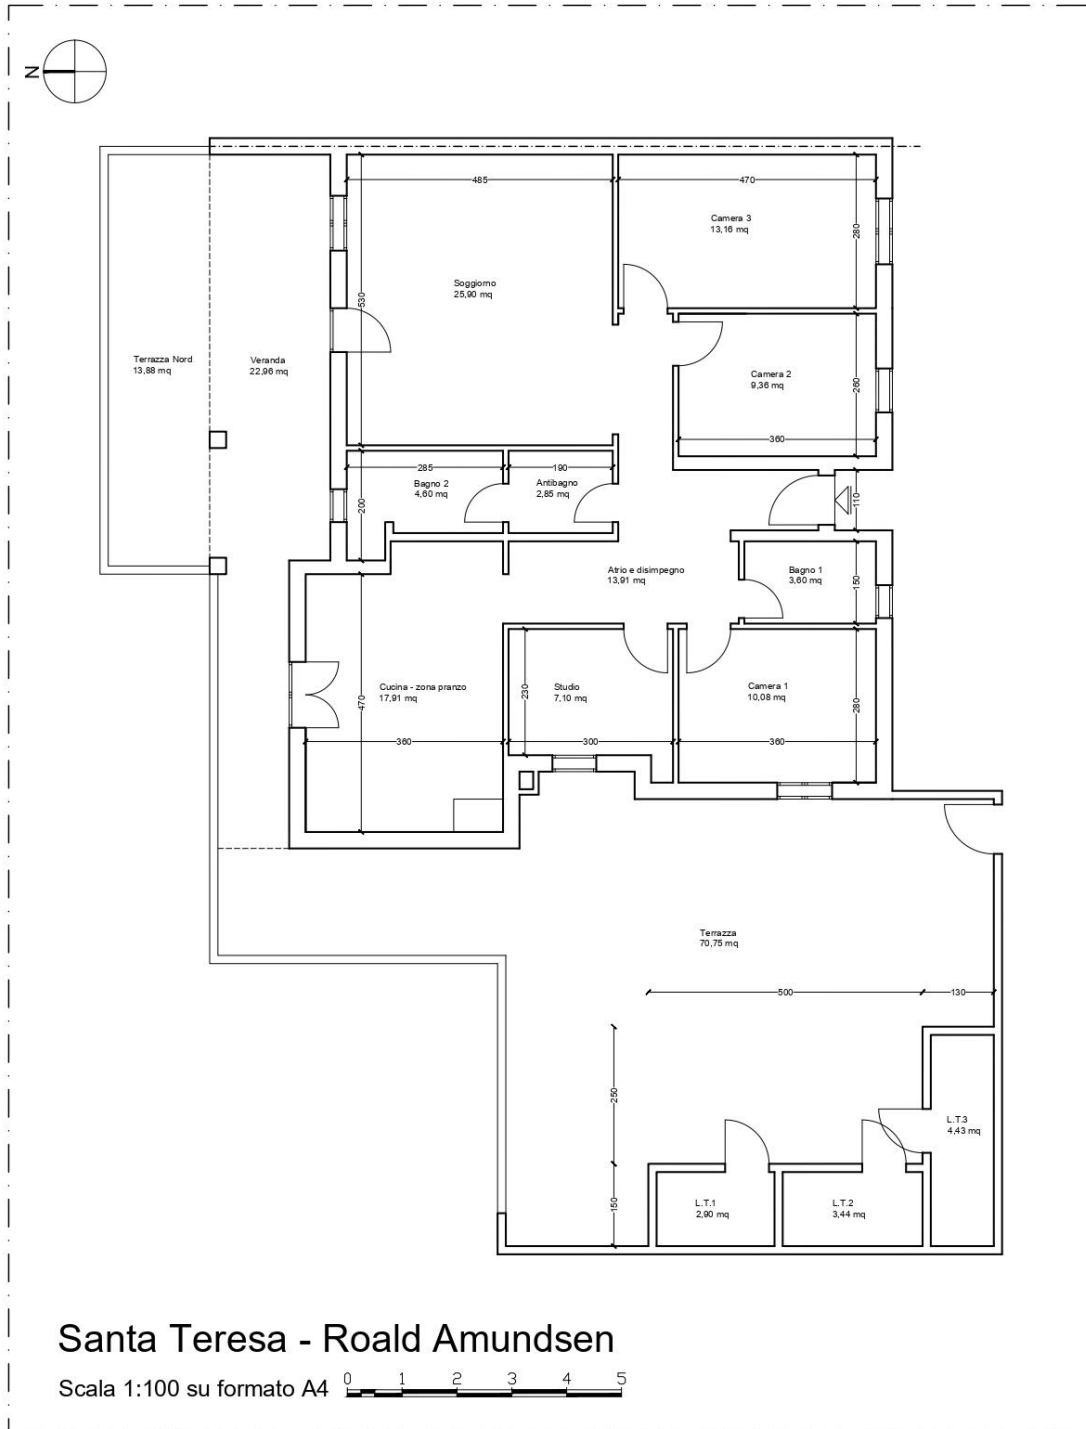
Planimetria dello stato di fatto – pianta piano terra
